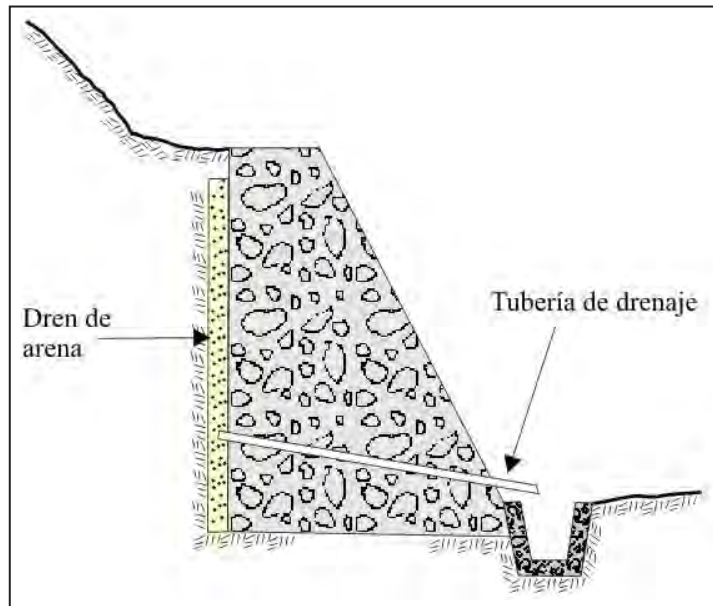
Muros de gravedad de concreto ciclópeo.
